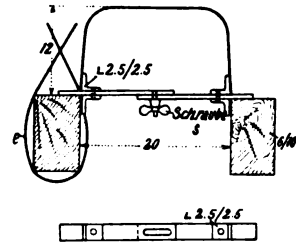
Abstandhalter für die Verschalung von Rippendecken mit Blechschablonen.
